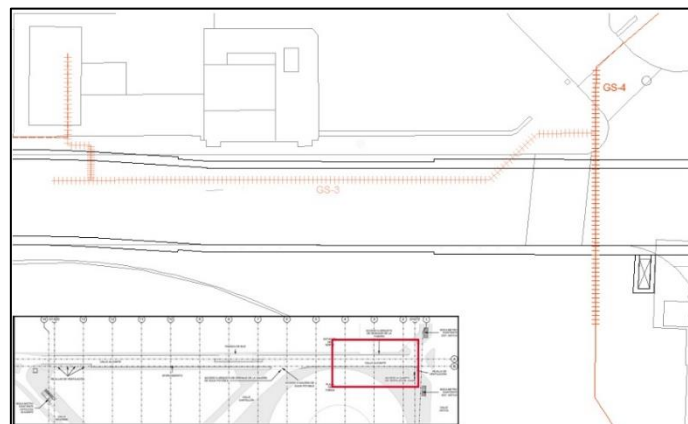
Plano de desvío GAS-BAJA-GS2,3-SR-CX-F5. Zona final
